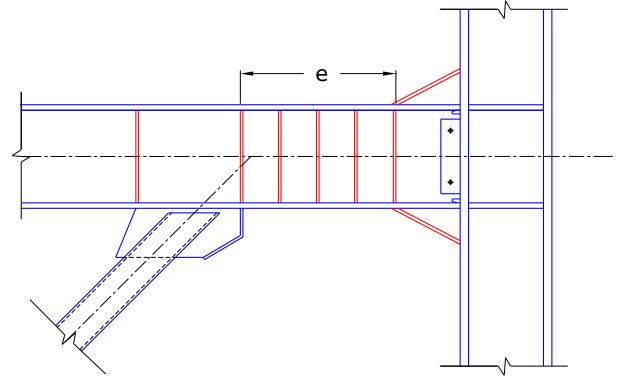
Detalle del enlace y conexión reforzada a la columna.
